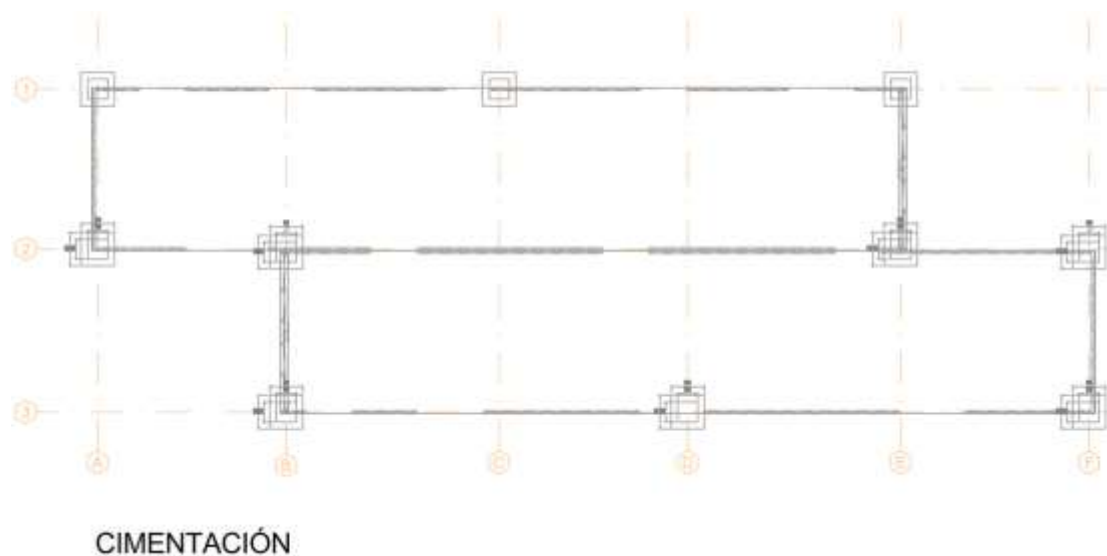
, Planta de cimentación, 2025-II, Wilson Lozano
